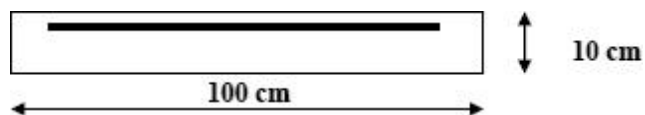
Section théorique pour le ferrailage de l’acrotère.
